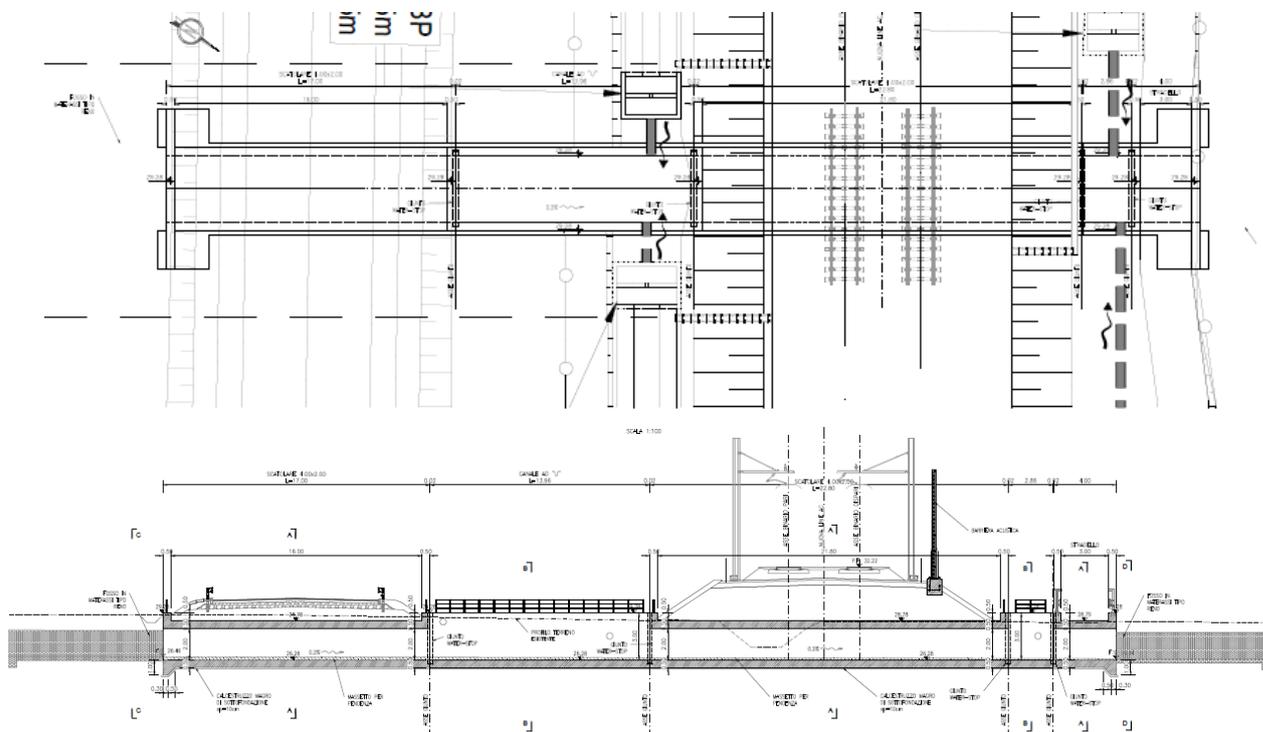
Pianta e profilo del doppio scatolare di progetto
